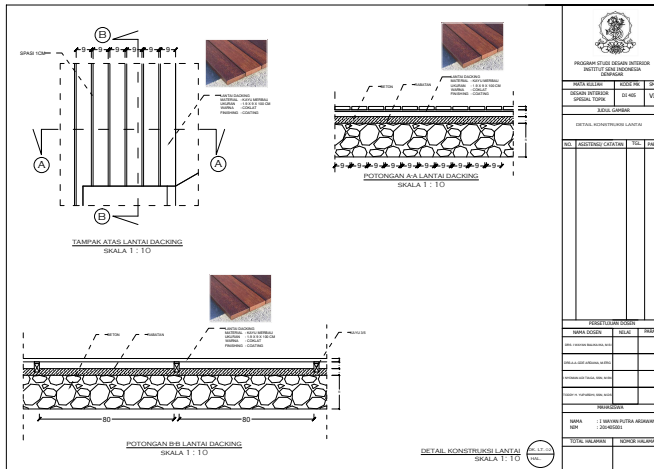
Contoh Desain Detail Elemen Estetik
